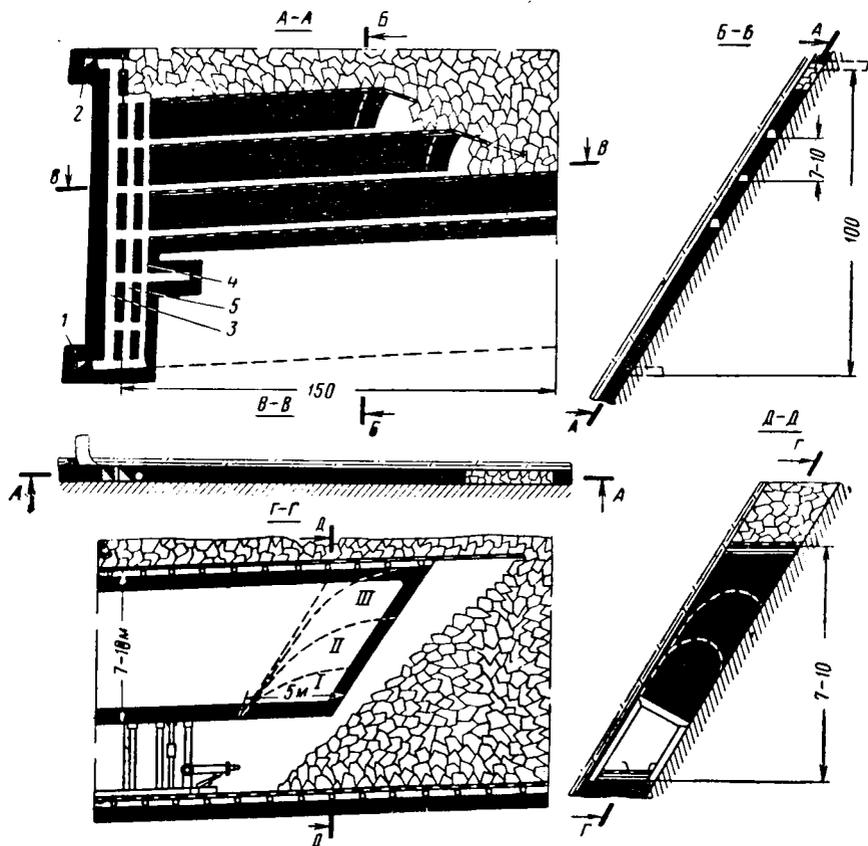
Система разработки подэтажной гидроотбойки с гибким перекрытием в каждом подэтаже:
